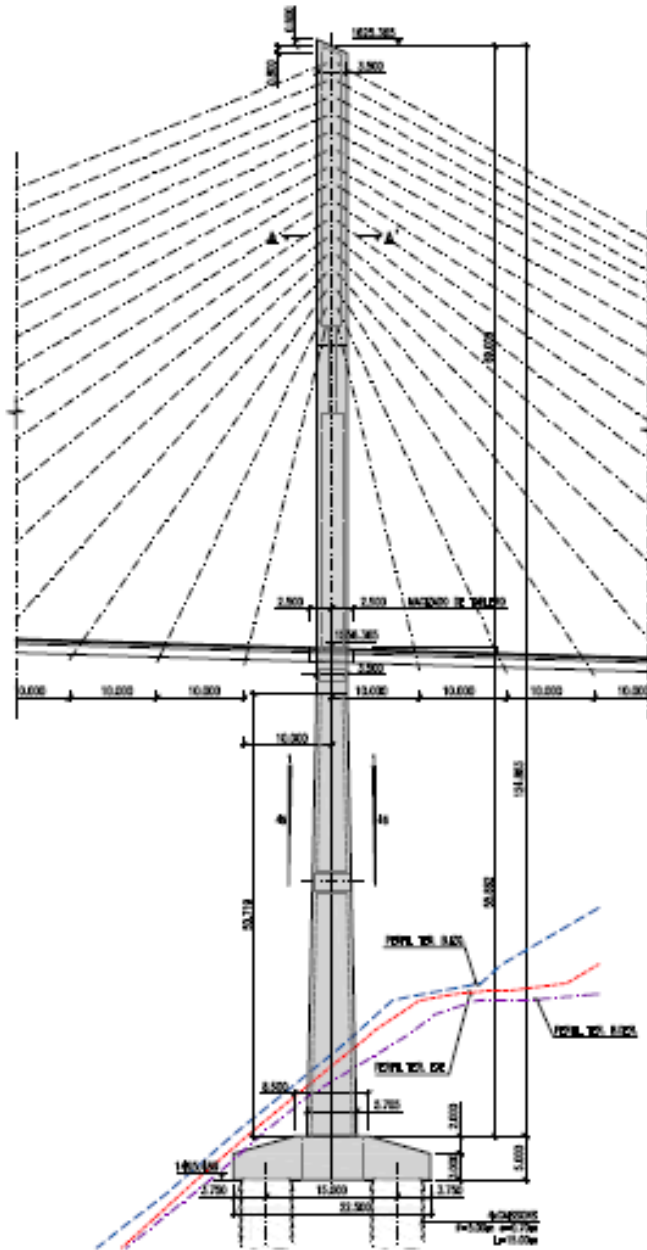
Pilon 4 Puente Atirantado Hisgaura
